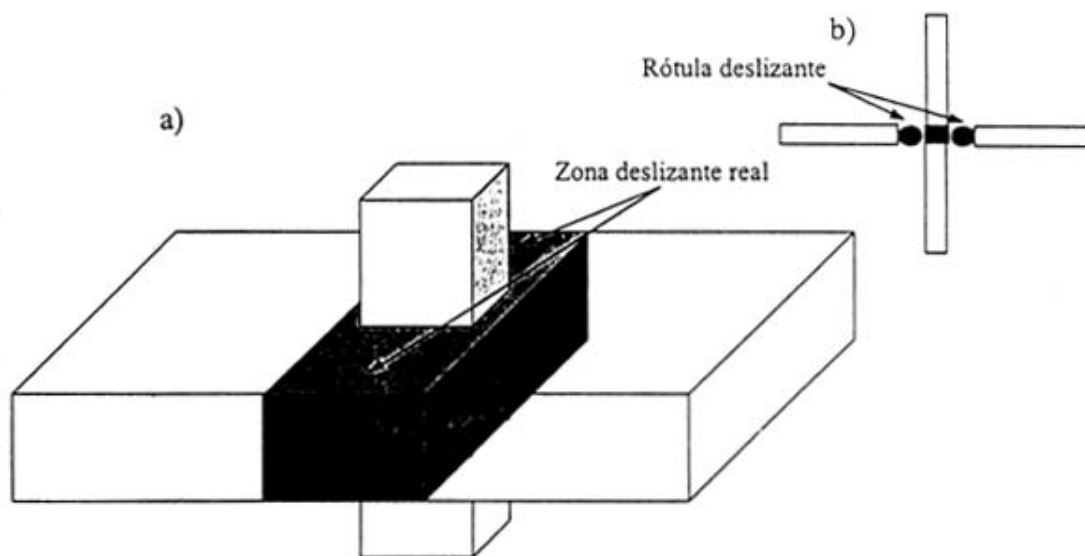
a) Junta viga plana-columna. b) Simulación de la junta con rótulas deslizantes.
